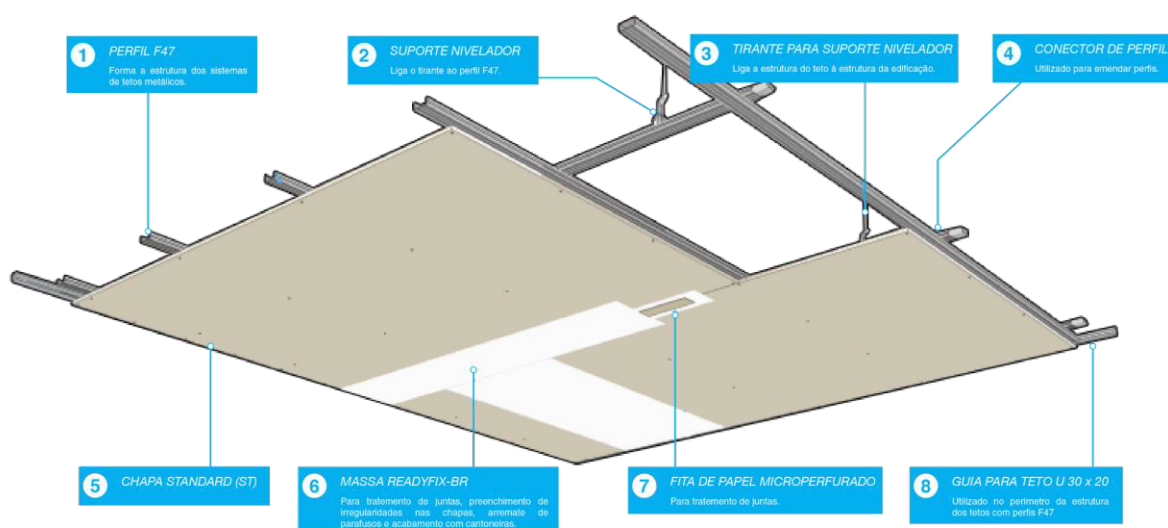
Esquema gráfico. Instalação de teto flutuante em sistema drywall
